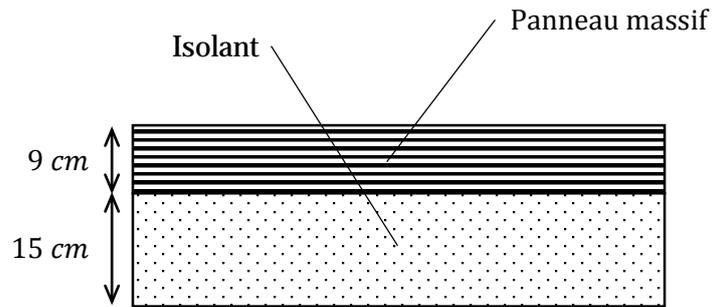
PAROI TYPE « PANNEAU MASSIF » (VUE EN PLAN)
